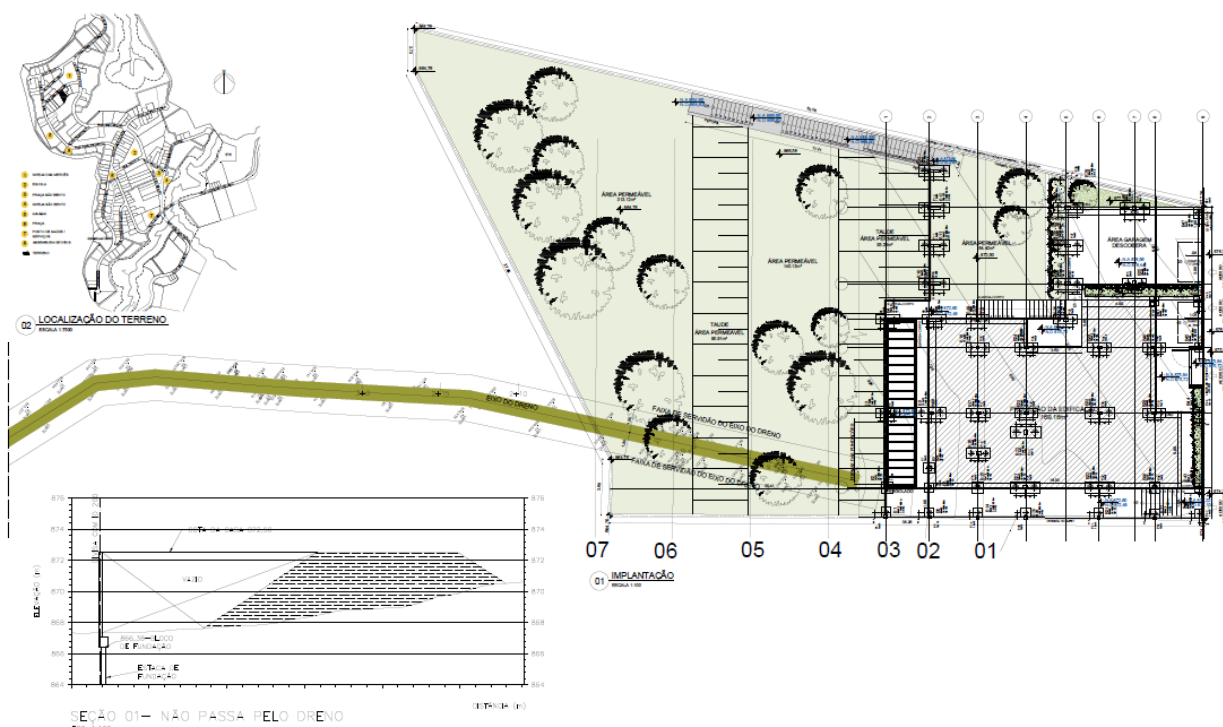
localização do dreno de talvegue secundário e da implantação da edificação nos lote de ID 210. Fonte: Fundação Renova. Projeto "sobreposição situação/estrutural/dreno – planta e perfil 01-02", enviado à CT-Infra em 31/03/2021, atendimento ao Encaminhamento E-50-5 da 51ª reunião da CT-Infra.
